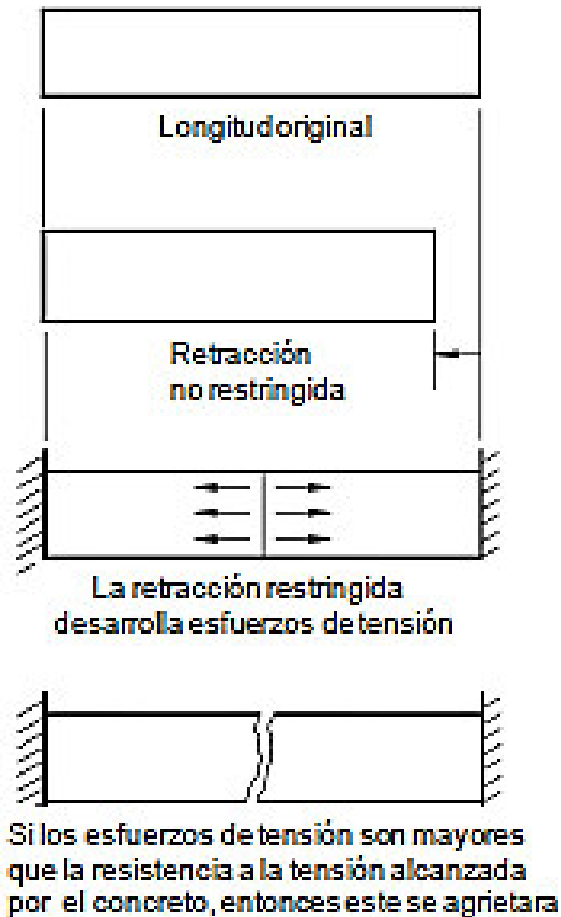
Agrietamiento provocado debido a contracción por secado [36]
